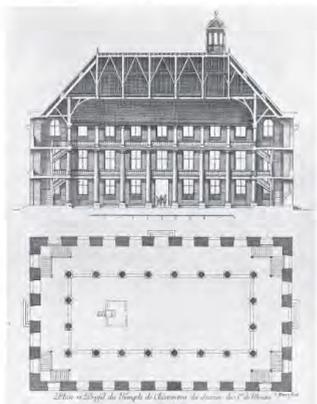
1623 Salomon de Brosse. Plan et coupe longitudinale
